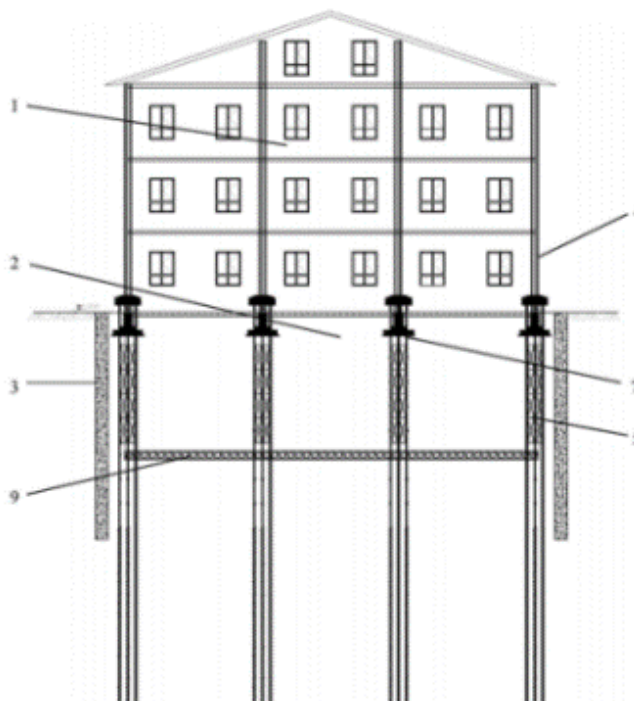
Схема устройства подземного этажа по патенту CN110886507A: 1 – здание; 2 - подземное сооружение; 3 - контур ограждения подземной части; 4 - существующие стены и/или колонны строительных конструкций; 5 – связи по сваям; 7 - оригинальный фундамент; 9 - нижняя плита подземного сооружения
